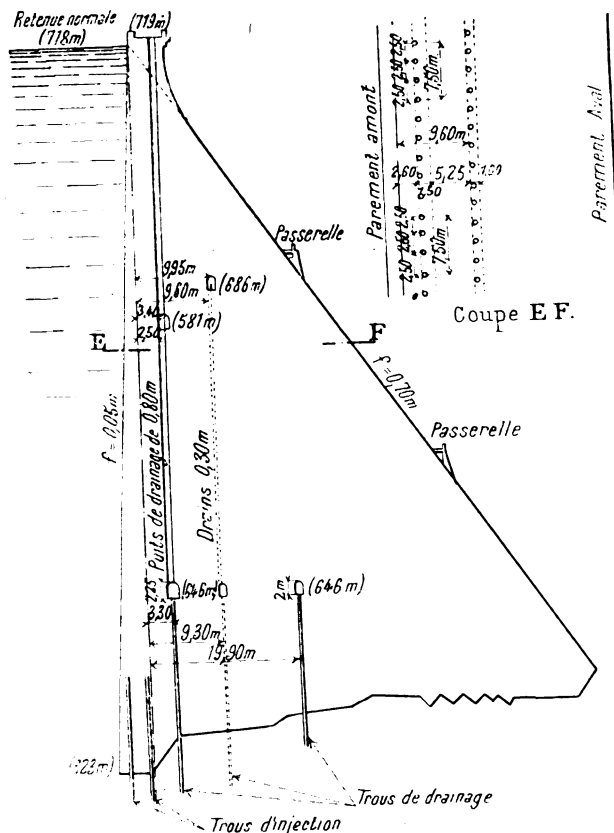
Profil du barrage du Chavanon et section horizontale indiquant le dispositif de drainage. L'exécution de ce barrage, dont le profil répond au type de la circulaire ministérielle, a été suspendue.
